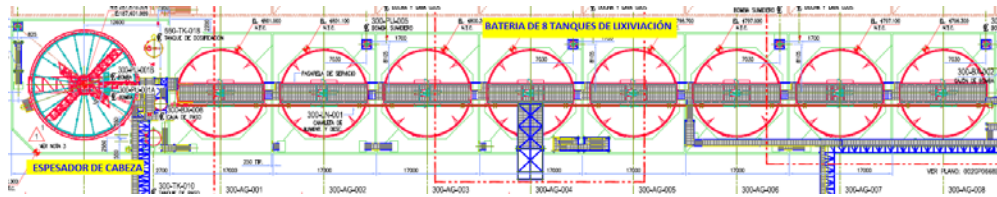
Espesador y Batería de 8 Tks de Lixiviación (Fuente: Empresa consultora ABC)
